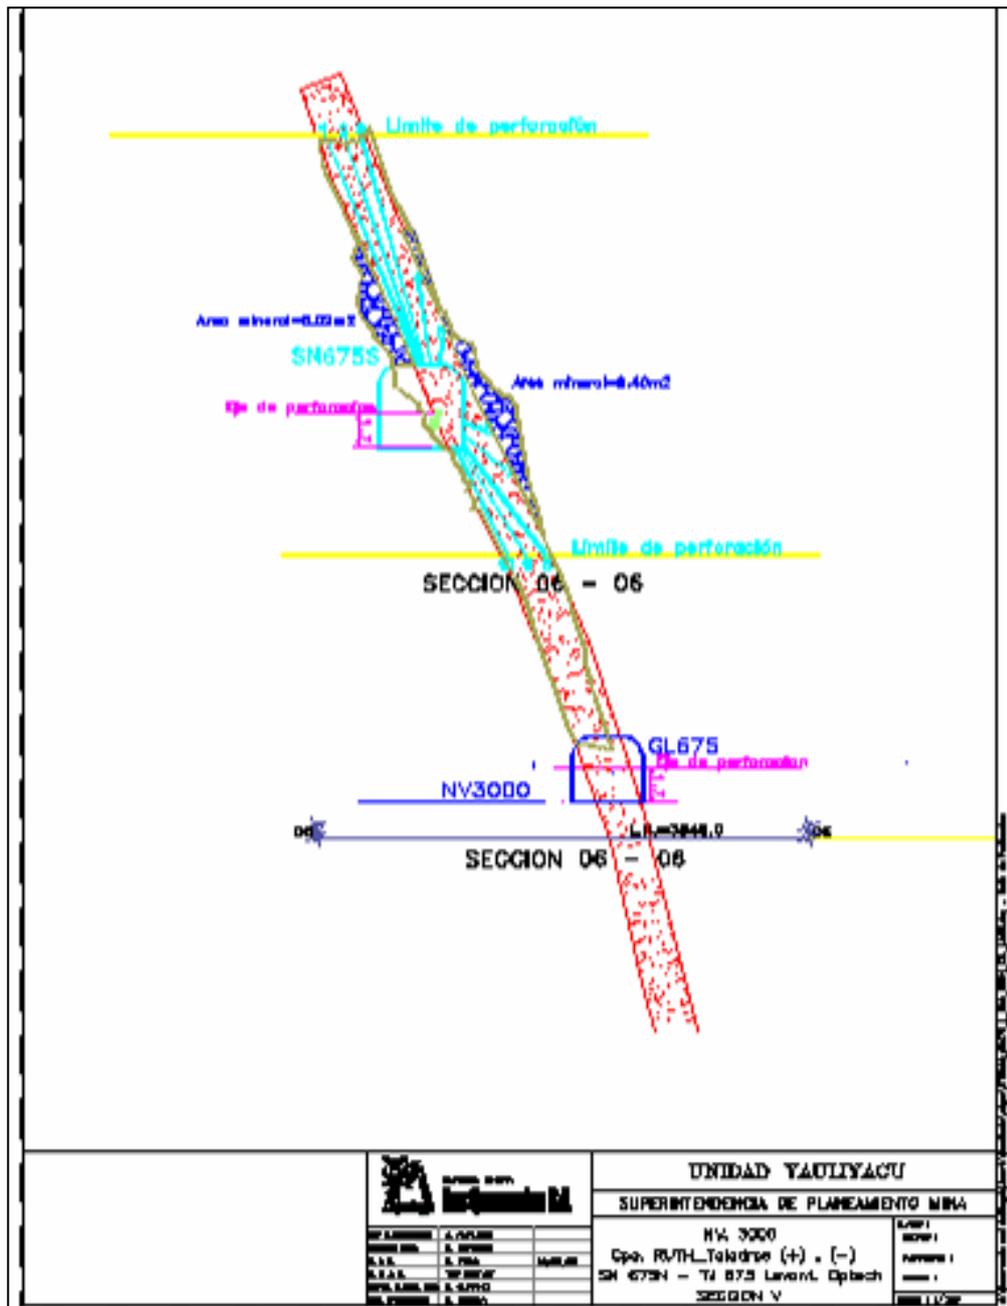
Levantamiento de un tajo después de la voladura en sección.
